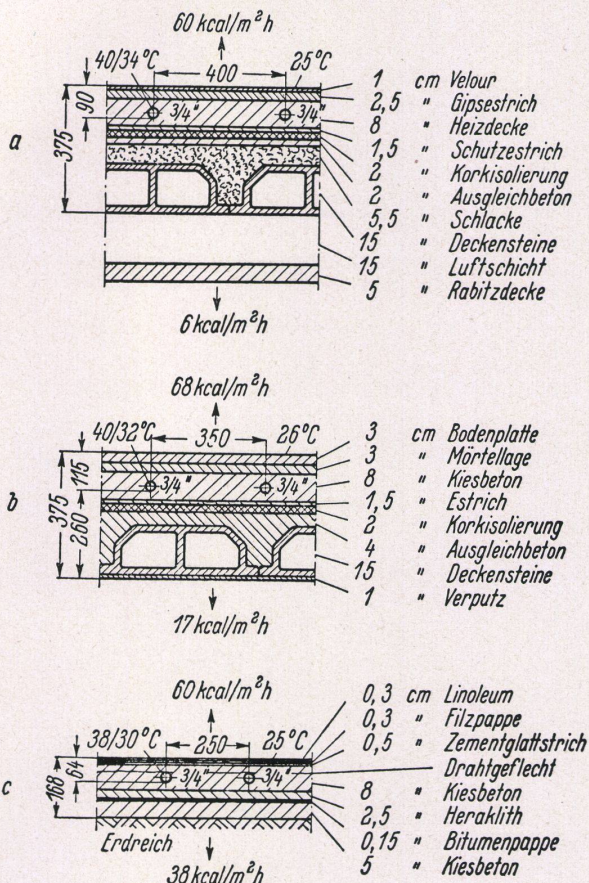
Ausgeführte Fußbodenheizungen a, b Hohlkörperdecken, c Betonfußboden über Erdreich
